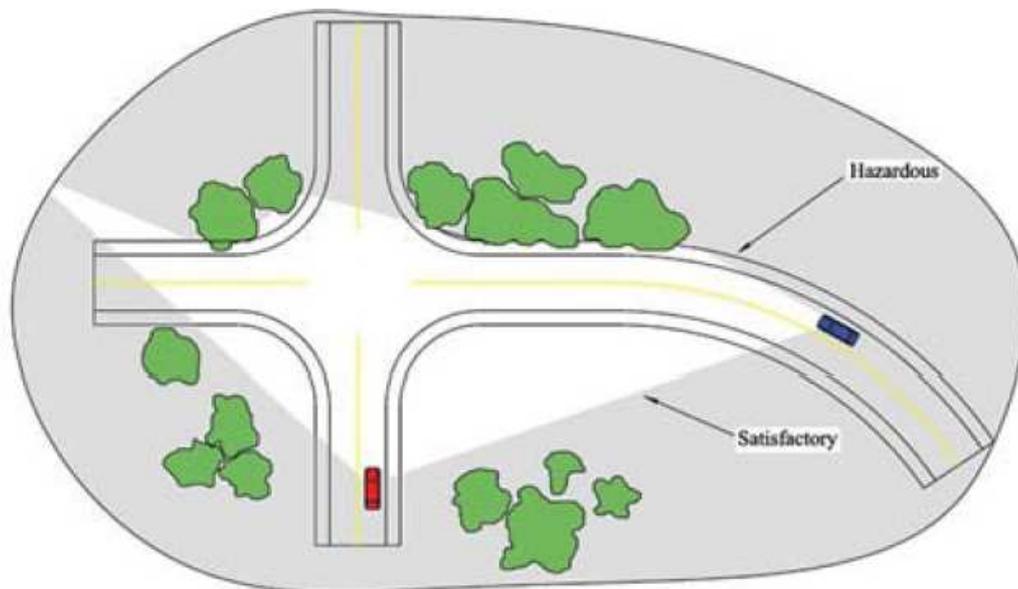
Esempio di individuazione dei triangoli di visibilità in un'intersezione stradale
